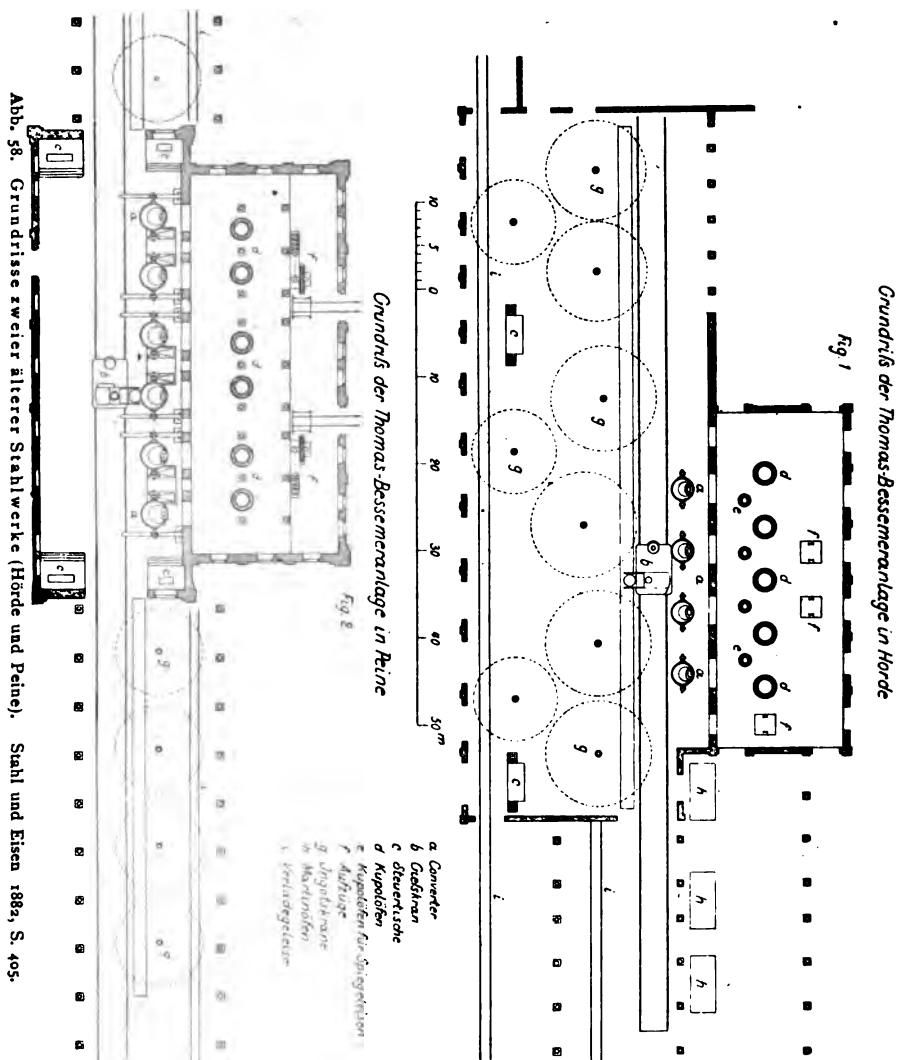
Grundrisse zweier älterer Stahlwerke (Hörde und Peine). Stahl und Eisen 1882, S. 405.
